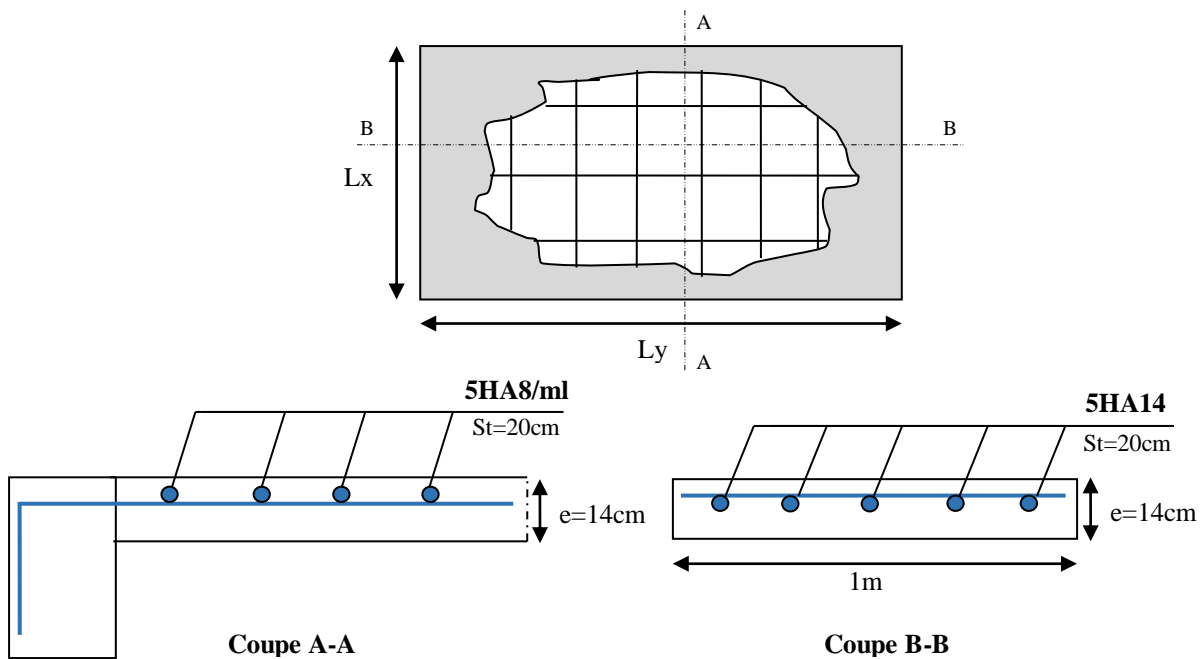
Schéma de ferrailage de panneau de dalle D5
